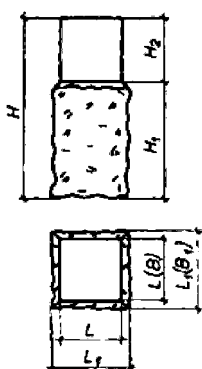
Roxor v betonovém bloku (základní odlehčená stabilizace)
